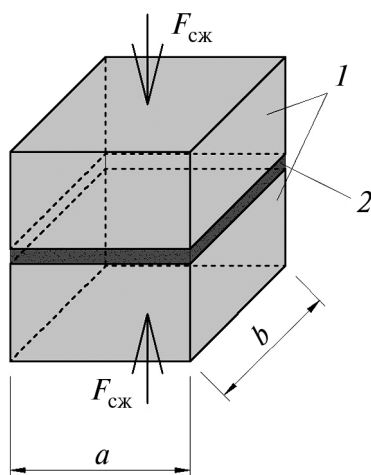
Схема испытания кирпича на сжатие: $F_{сж}$ — сжимающая нагрузка; a , b — размеры поперечного сечения; 1 — кирпич; 2 — цементно-песчаный раствор
